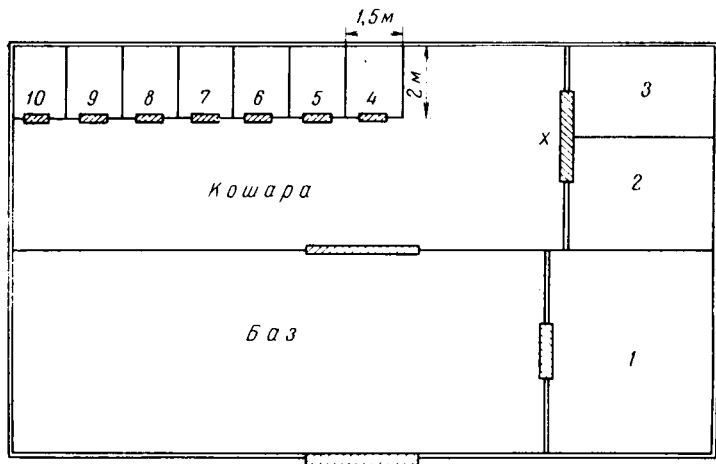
Примерная планировка кошары для проведения ручной случки коз:
